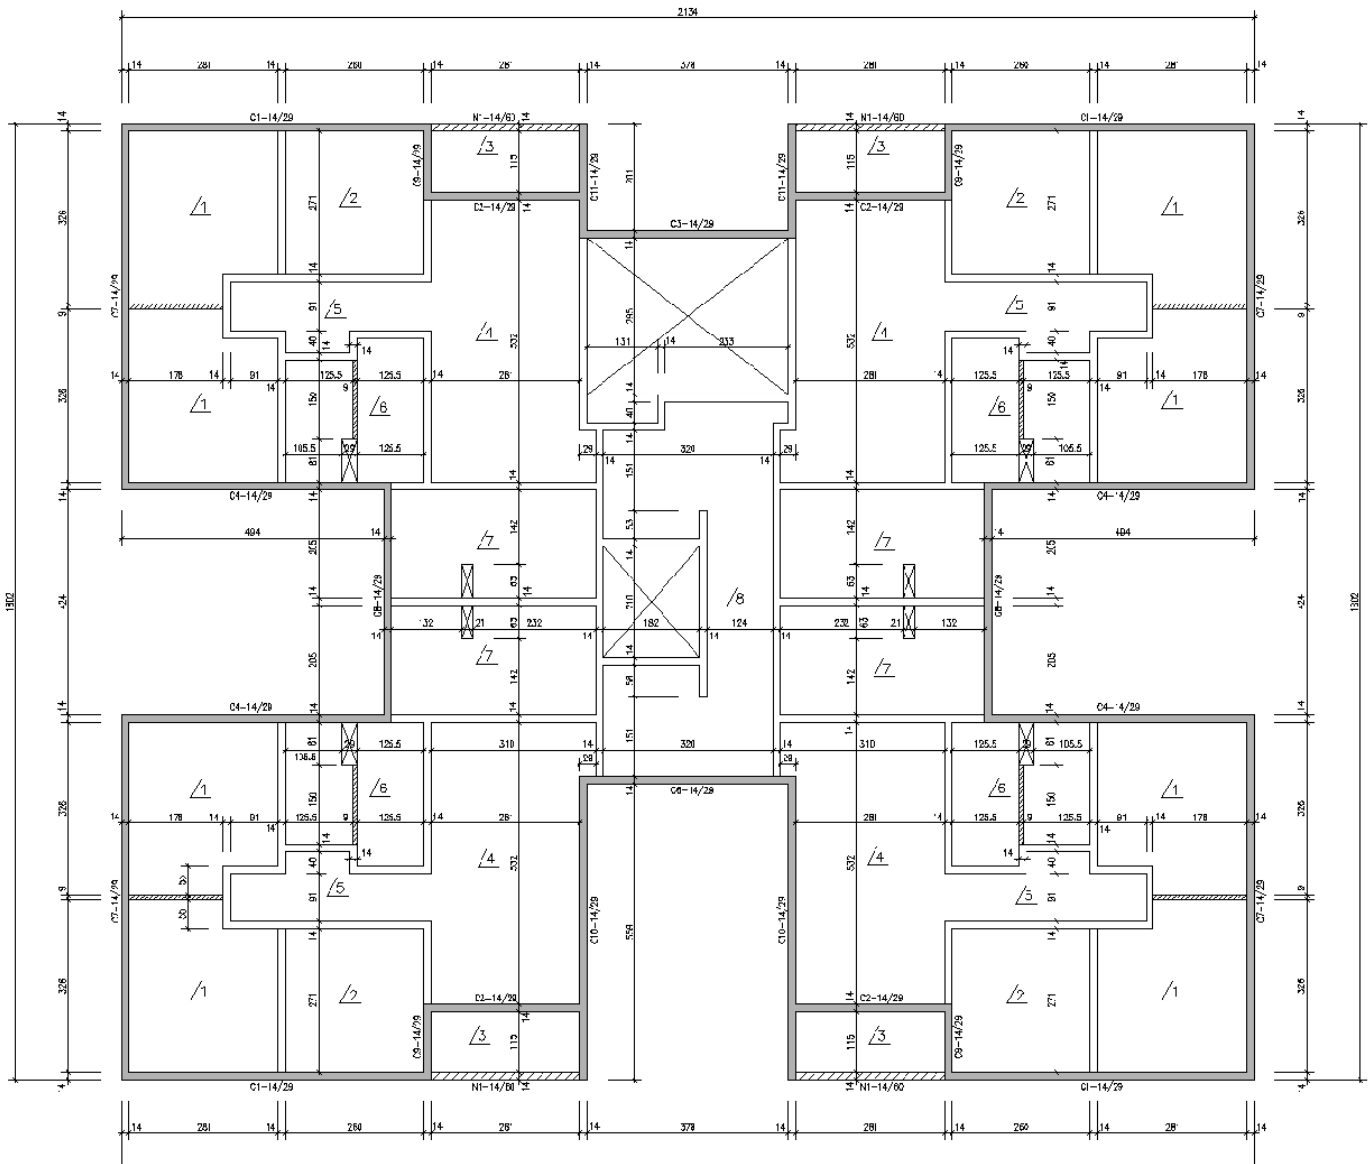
Formas das lajes do pavimento tipo.
